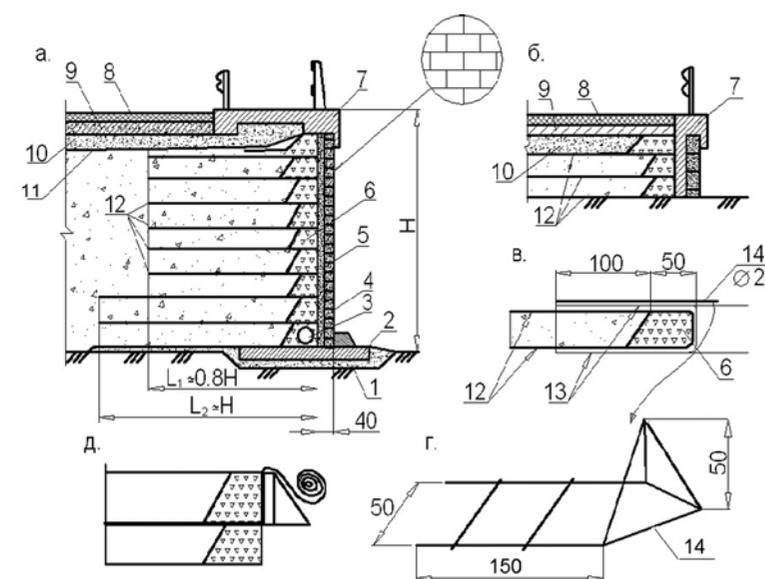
Армогрунтовая подпорная стена с лицевой стенкой в виде железобетонной плиты с облицовкой стенными камнями из вибропрессованного бетона:
